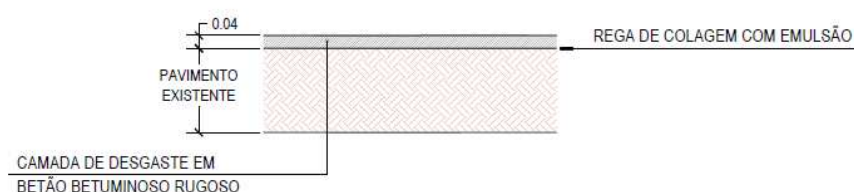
| Pavimentação - Zonas de Fresagem e Repavimentação
